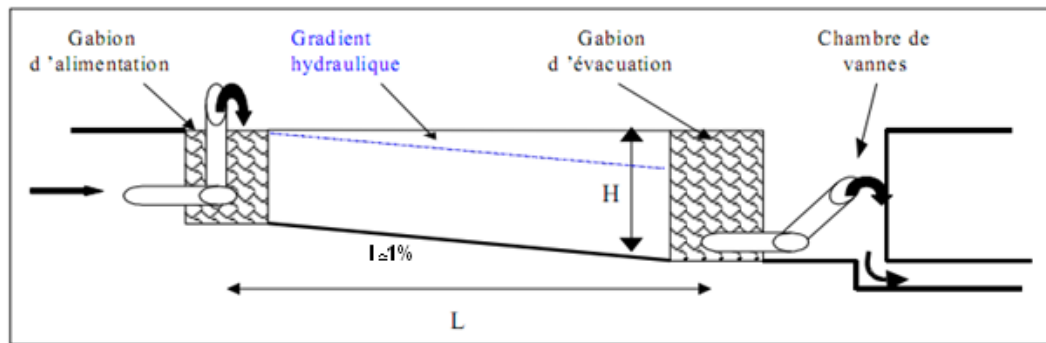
Dimensions types d'un bassin à écoulement horizontal [52].
